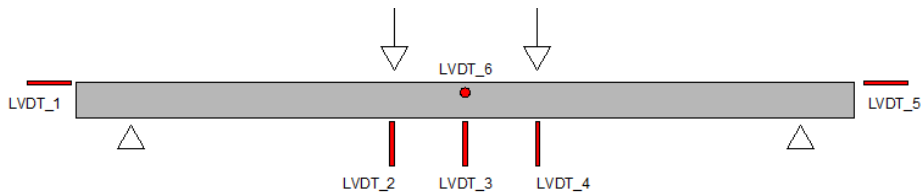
Situación de los LVDT, en las vigas híbridas.
